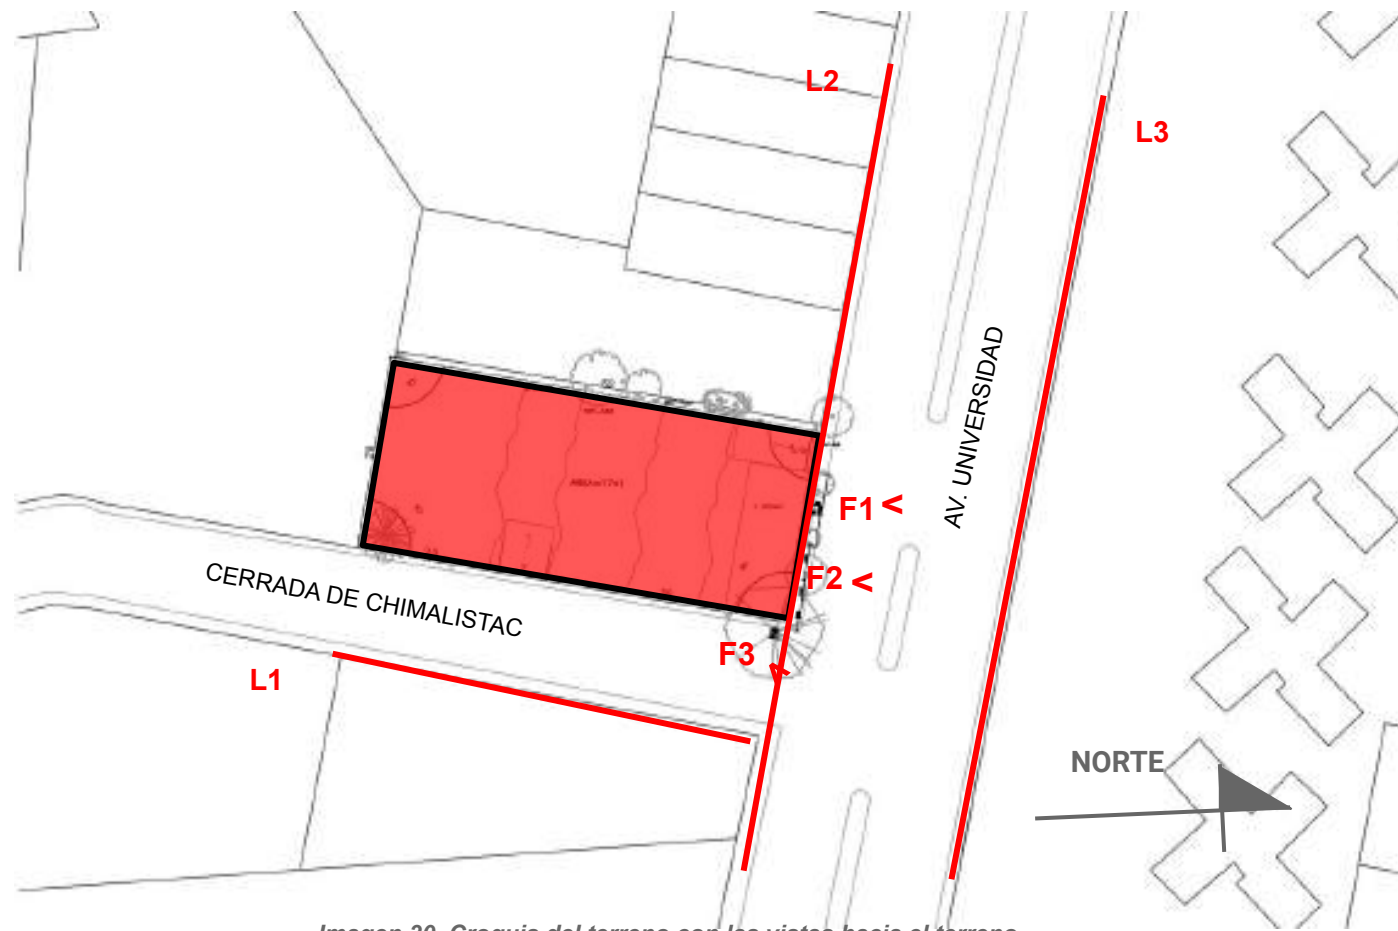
Croquis del terreno con las vistas hacia el terreno.
